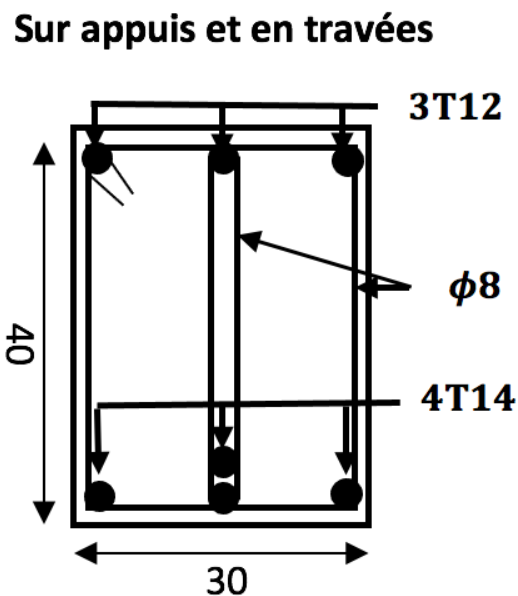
Schema de ferrailage de la poutre palière
